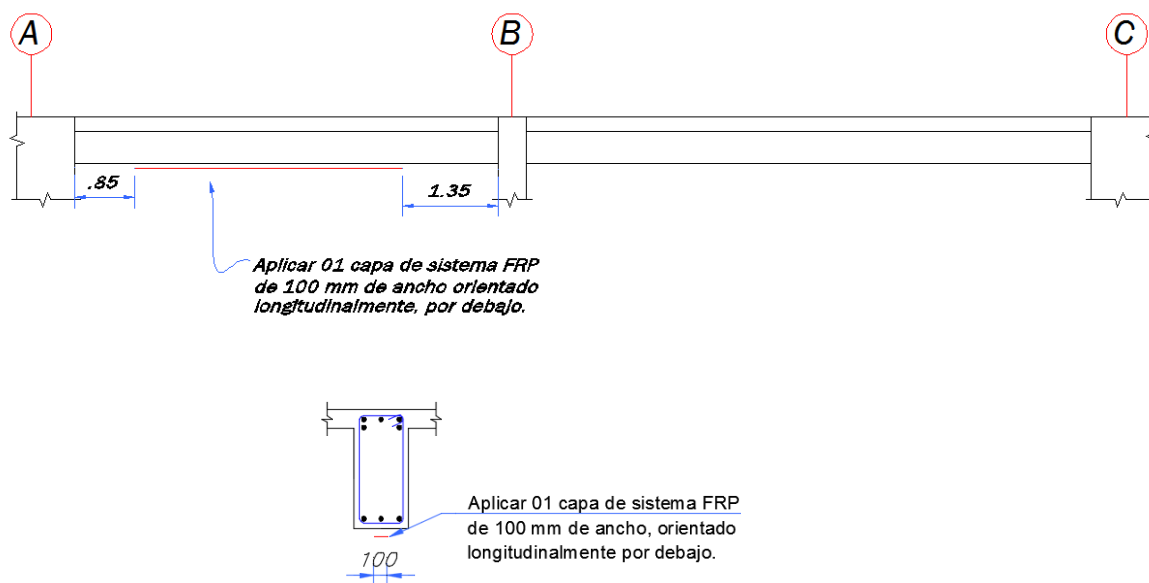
Solución 02 – Elevación y Sección transversal del diseño del refuerzo en la zona positiva de viga por redistribución.
